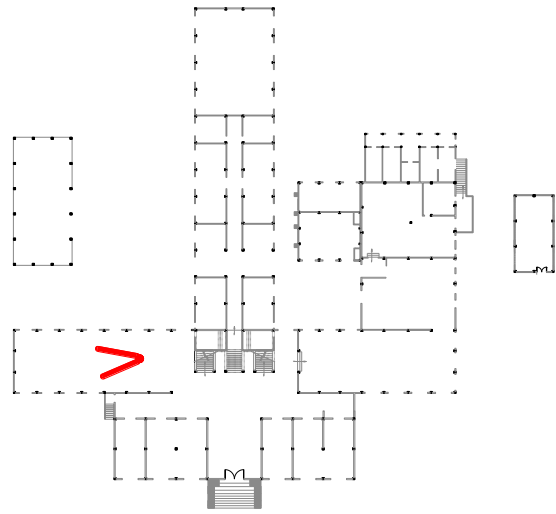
Vista estructura existente, incorporación de pérgolas. Adaptación de espacio interno a externo
